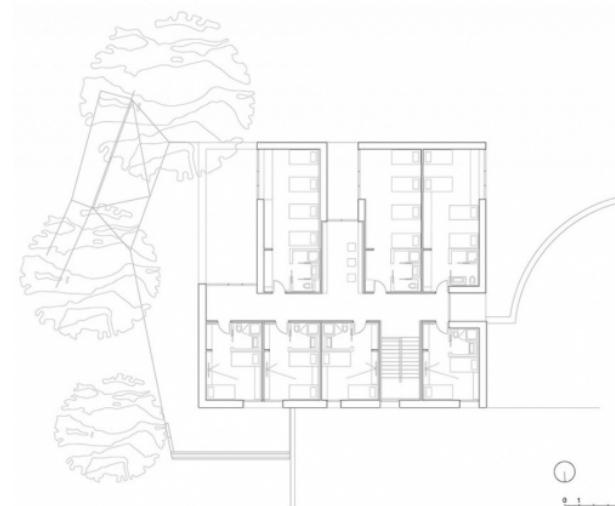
Grundriss OG Jugendherberge Punkl
